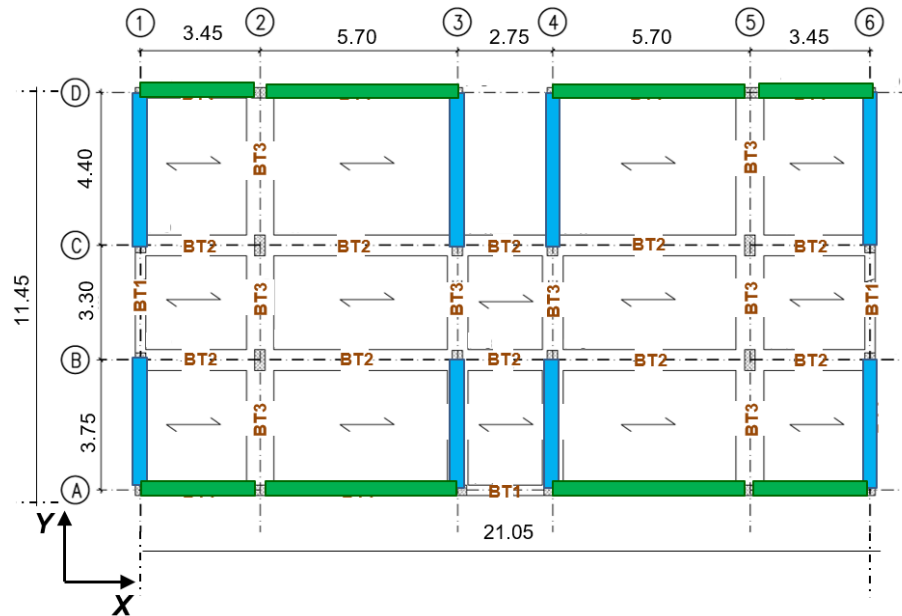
Posizioni in pianta del sistema di controventi dissipativi, individuate dai rettangoli campiti in verde e in blu
